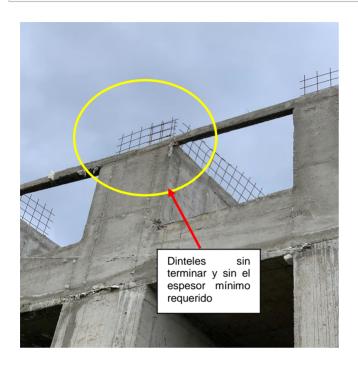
Concreto con pandeos en muros estructurales torre 9 y 10, dinteles sin terminar y sin espesor mínimos exigido por diseños estructurales y planos, Concreto con socavación debido a la humedad presentada en el piso 2 torre 9, Proyecto denominado "Urbanización Santa Sofia II", (Municipio de El Colegio, 30 de mayo de 2019, 3:00 p.m.)
